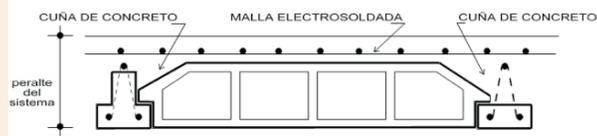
Detalle de Cuña de concreto con vigueta de alma abierta
